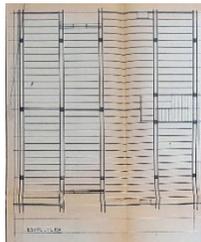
Plantas Estructura B-3-4. 1964. Fuente: Archivo Municipal da Coruña
